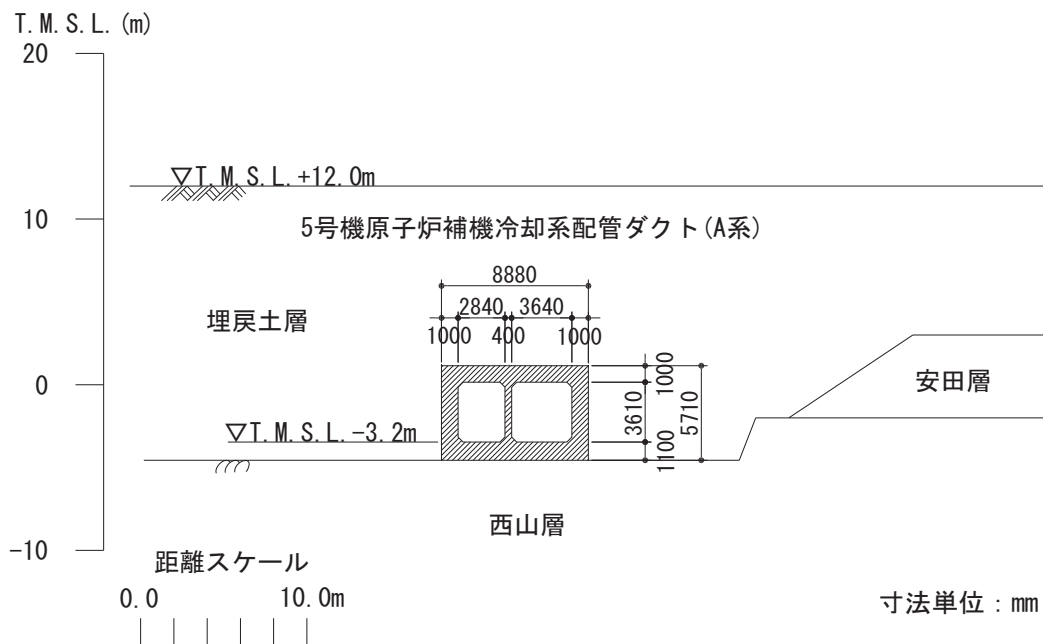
原子炉補機冷却系配管ダクト (A系) 断面図 (D-D断面)
